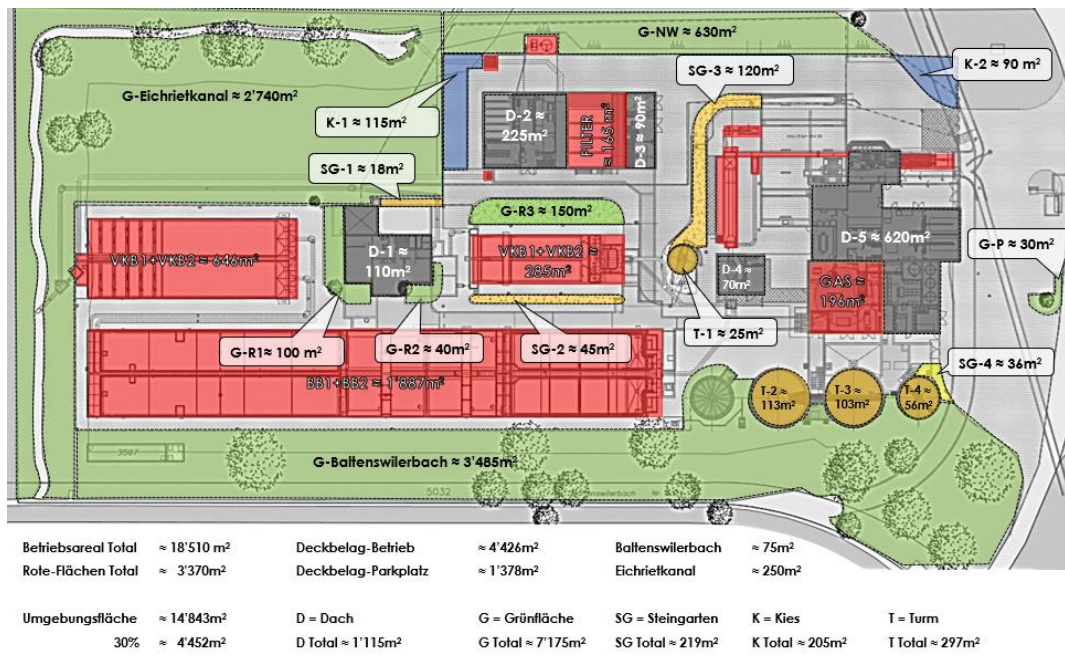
Grundrissplan mit Teilbereichen und Flächenangaben (Siehe Original im Anhang)
